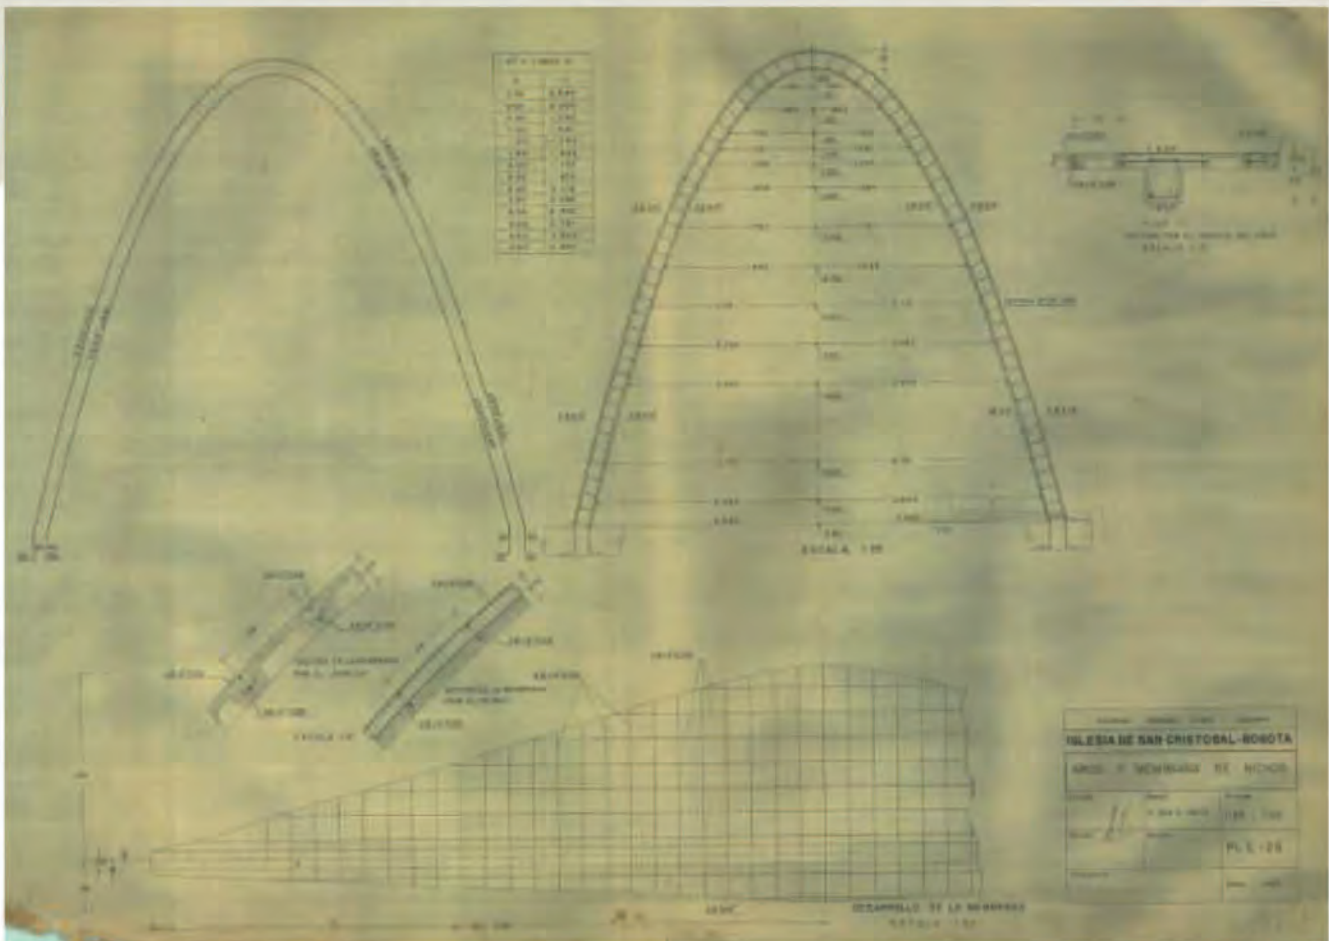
Plano de Ingeniería para los dos arcos laterales de entradas que estarían a lado y lado de la nave, Ing. Guillermo González Zuleta. Plano de 1954.
